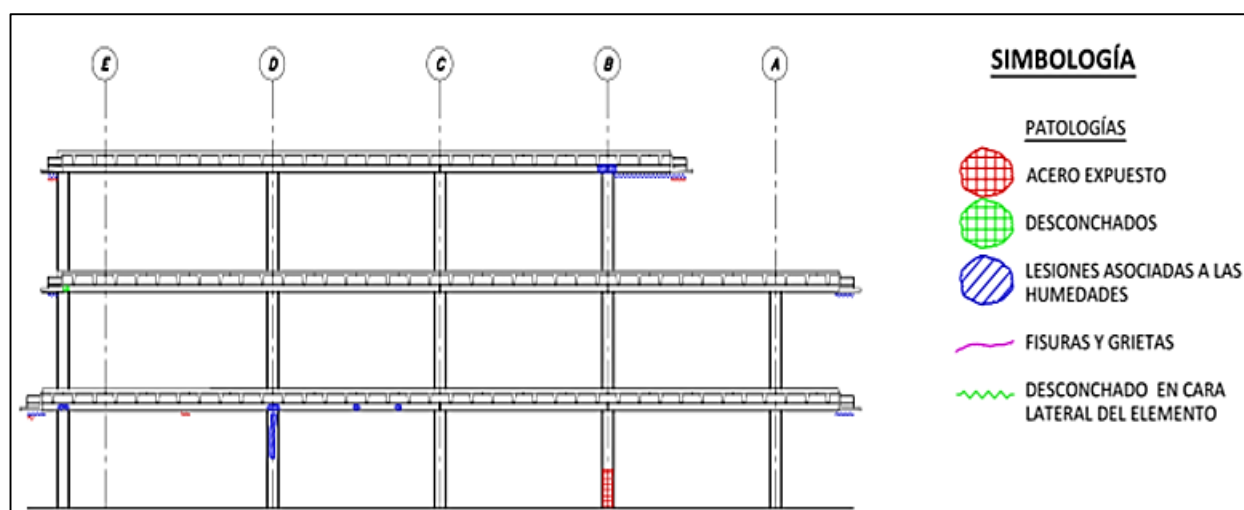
Plano del levantamiento patológico de la obra objeto de estudio
